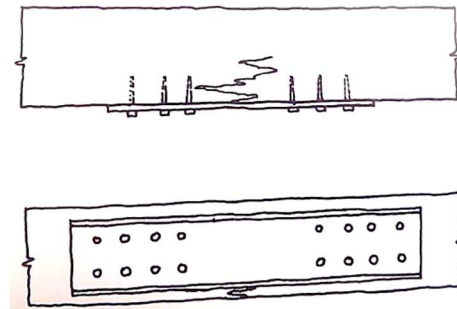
Reparación de una rotura con pletinas metálicas.
